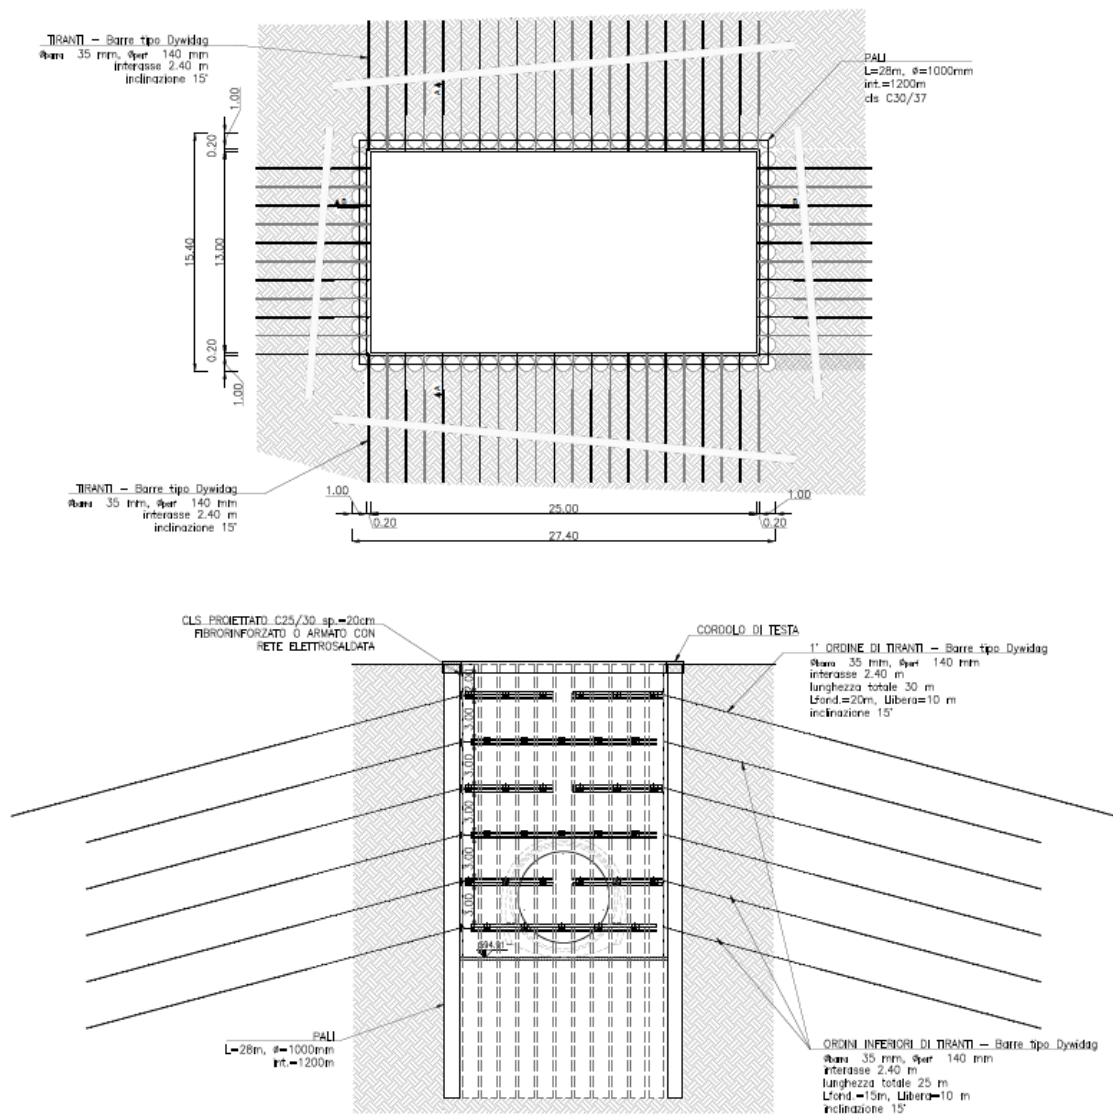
Pozzo forzato: planimetria e sezione trasversale della configurazione iniziale
